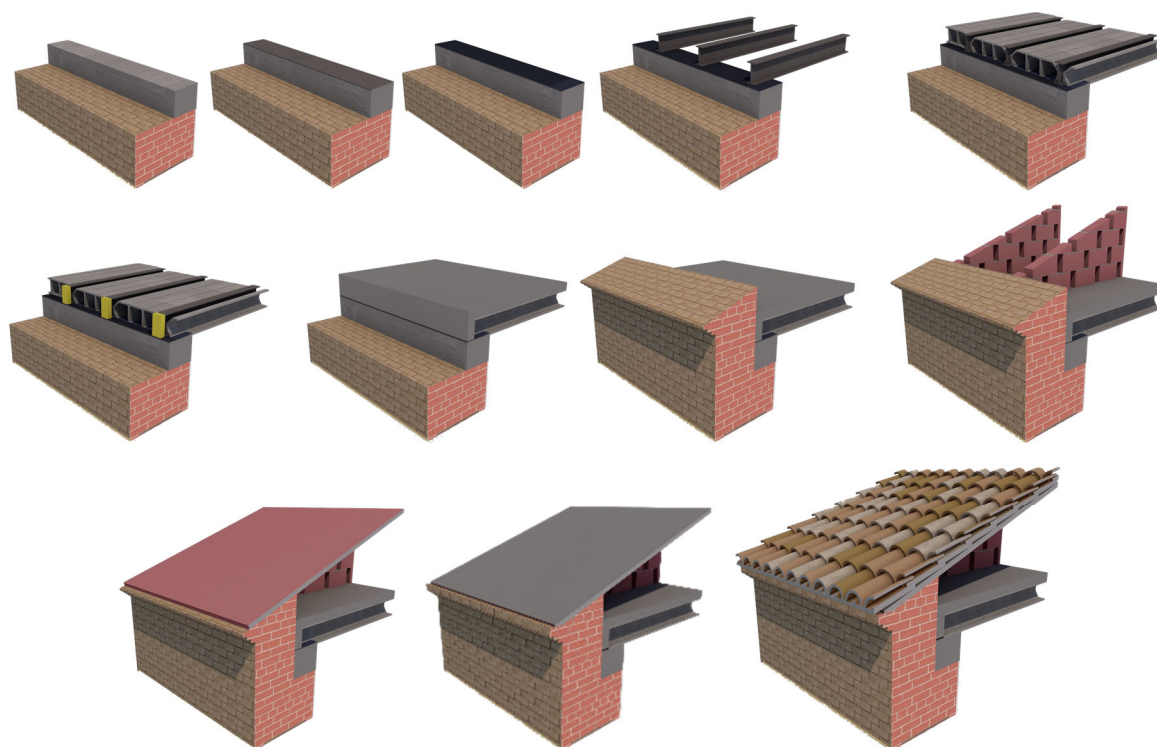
Fases de la solución constructiva alternativa al último proyecto de intervención (1989). Modelado y renderizado en ArchiCAD (García, 2015).
